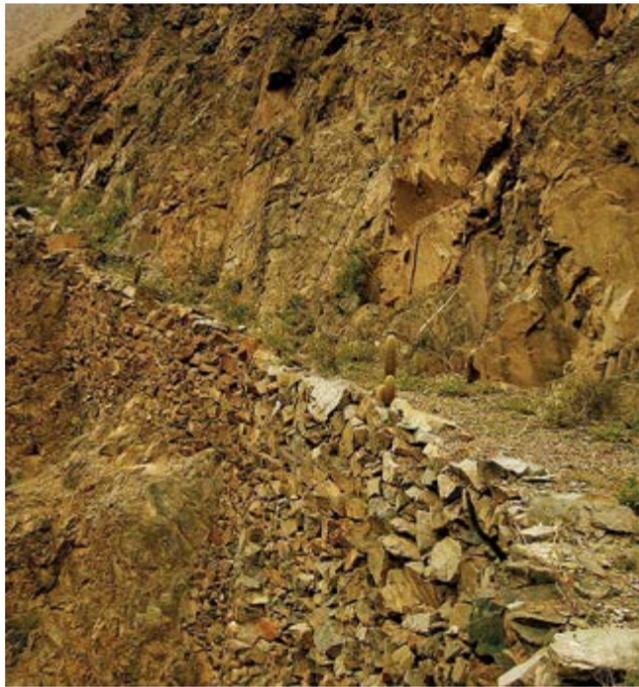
Camino con muro de contención en Antioquia, valle de Lurín. Tramo Xauxa - Pachacamac. (foto por G. Casaverde)
